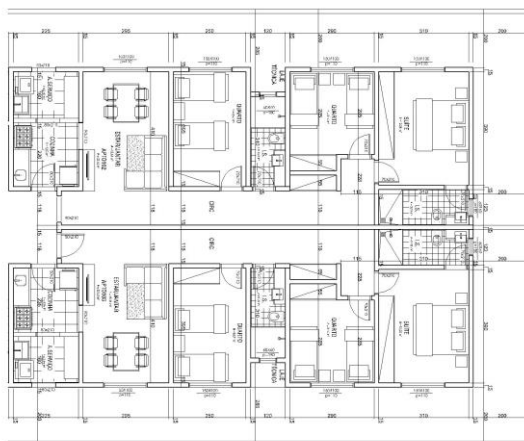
Apartamento tipo 1. Fonte: RDB Construtora.
